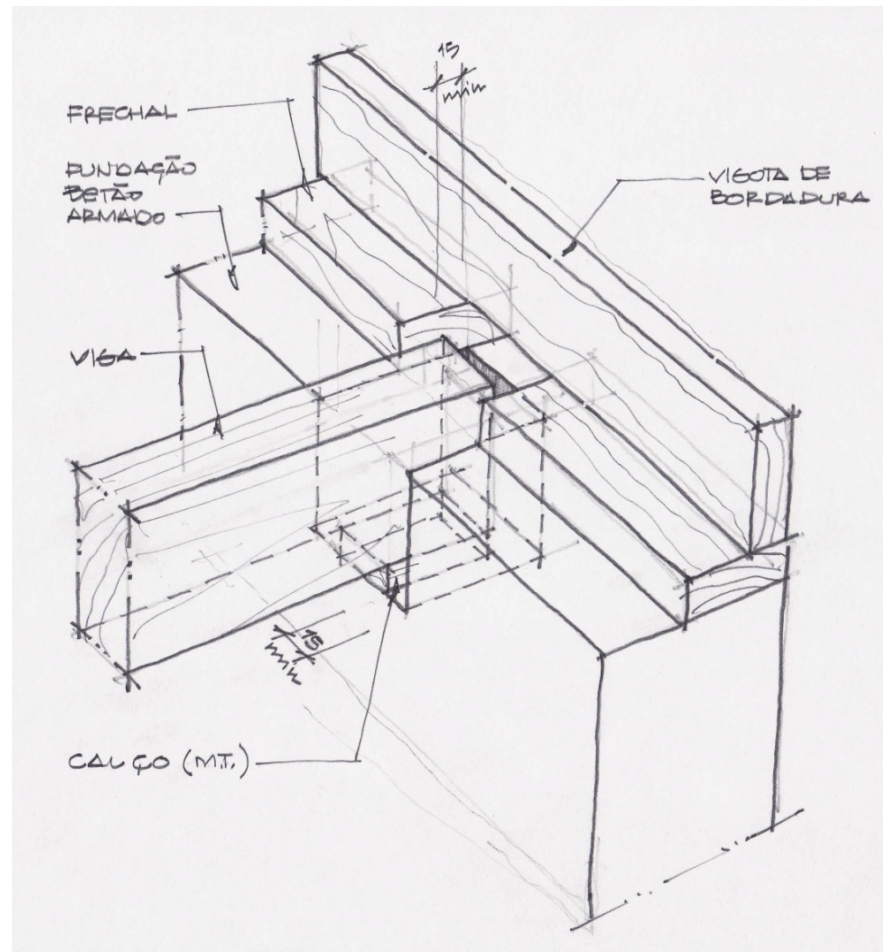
Protecção contra a deterioração da construção no contacto com elementos de betão. (des. autor)
